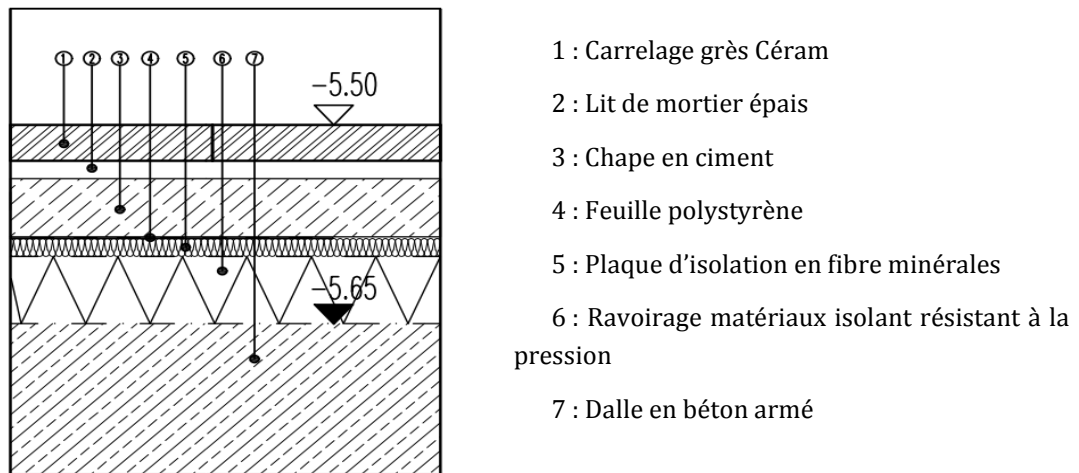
Exemple de plancher utilisé (plancher des locaux techniques)
